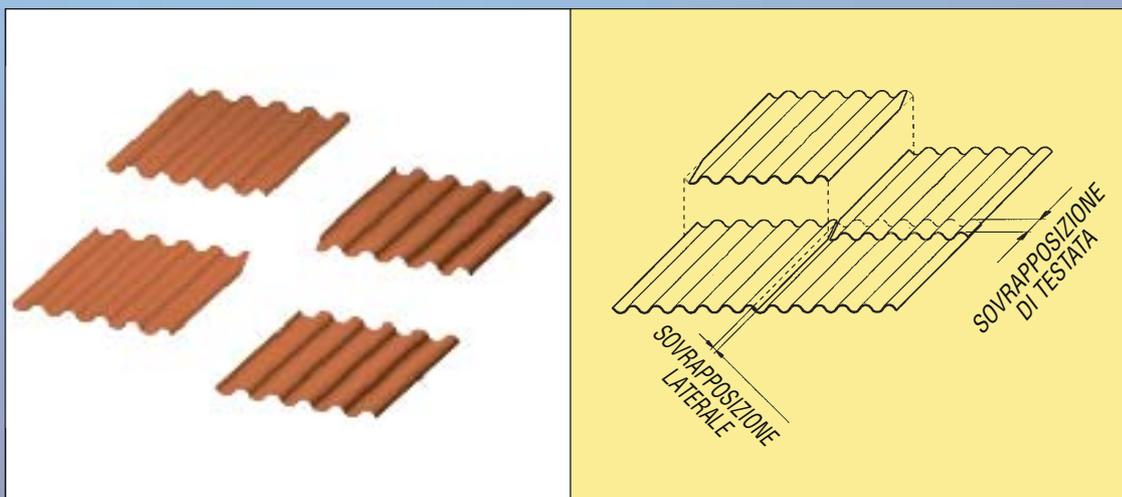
Dettaglio dello smusso delle lastre e installazione
